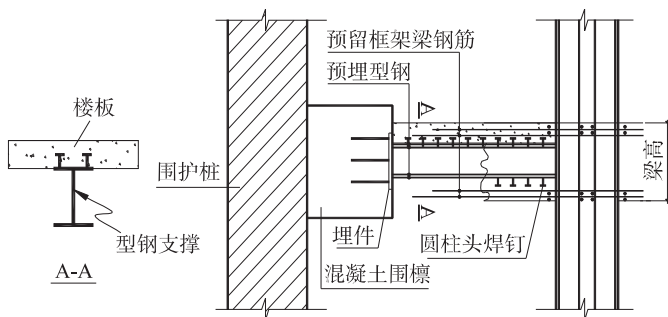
围护墙与地下结构用型钢混凝土组合支撑连接
